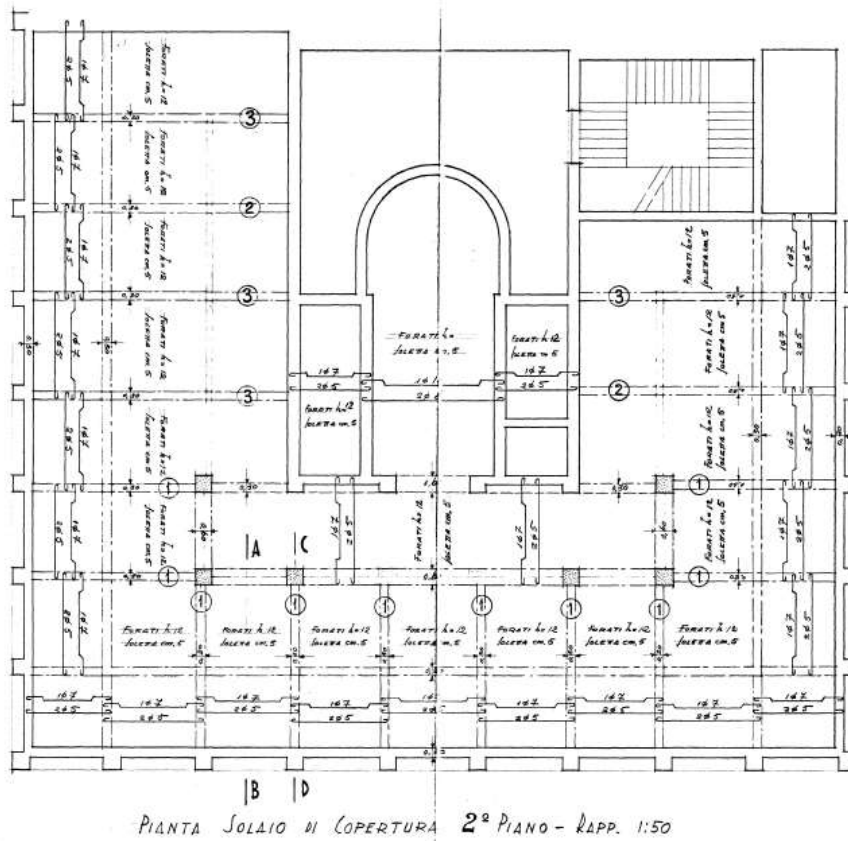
Pianta solaio di copertura piano terzo (da progetto preliminare), con indicazione delle travi in c.a.
